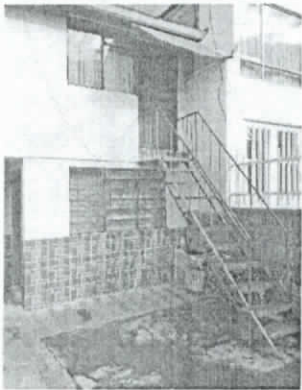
Fachada predio ubicado en la calle 98A No.32-14
